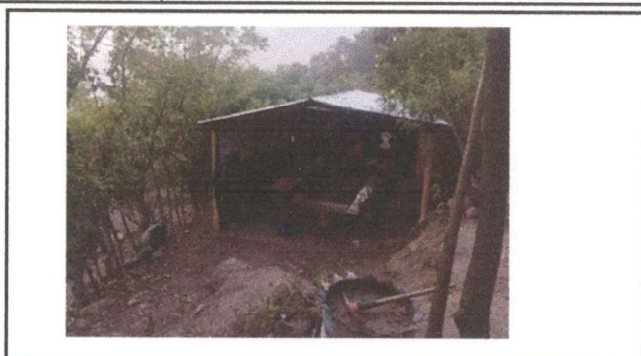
aula a remozar: cuenta con paredes de nylon y techo de lámina en mal estado
